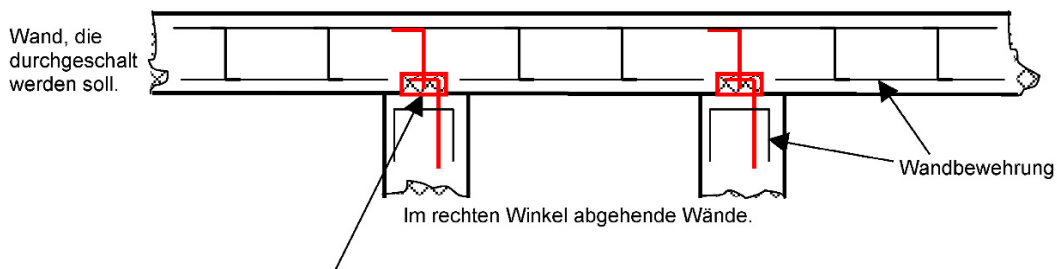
Ausklappbarer Bewehrungsanschluss zur Bewehrungsfortführung für rechtwinklig abgehende Wände
